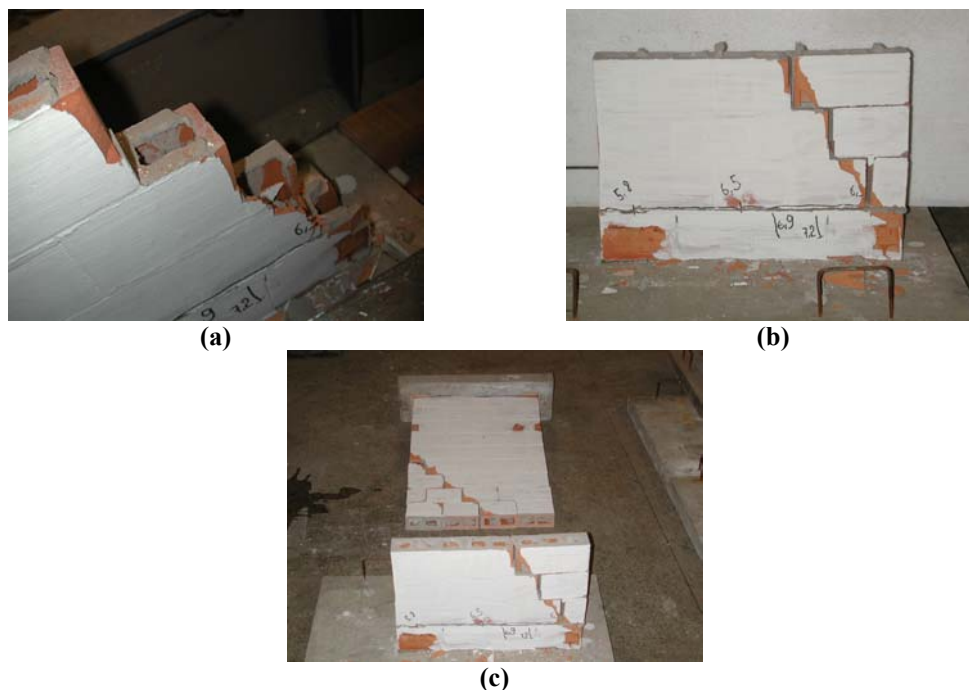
Modo de ruptura apresentado pelo modelo PISG1: (a) Detalhe do lado comprimido imediatamente após a ruptura; (b) Detalhe da fissuração na base do painel; (c) Montagem do painel para avaliação da fissuração final.
